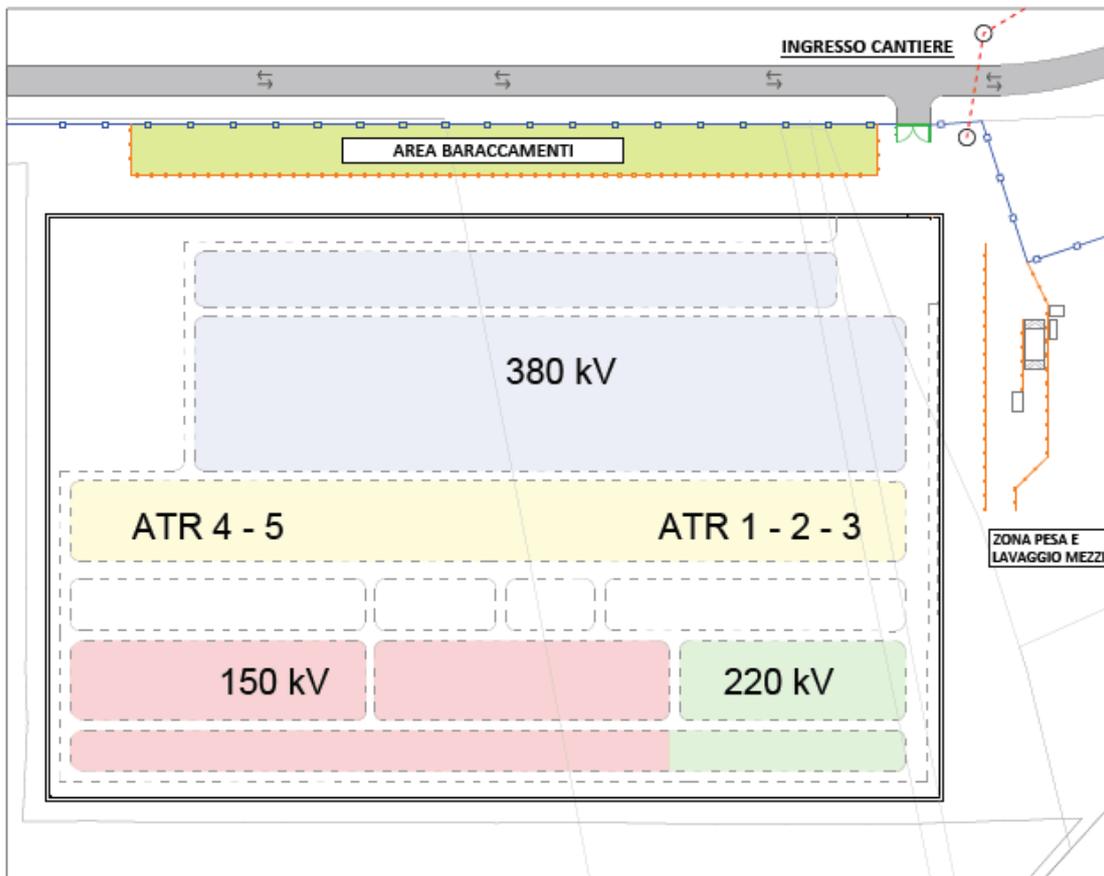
Organizzazione delle aree della Stazione Elettrica. Estratto dal Disegno DS11006BCSI1860 in allegato
